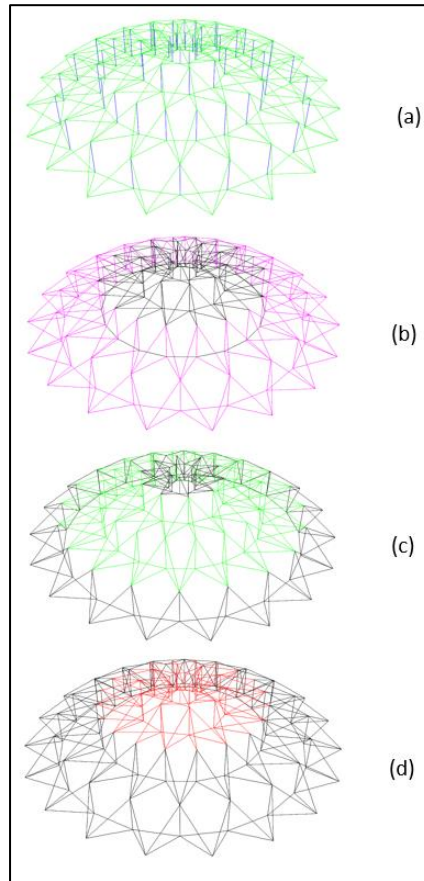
Secciones en las que se dividió la estructura para determinar el nivel de pretensado en los cables. (a) Estructura original, (b) Primera sub división que contempla nivel 1 y 2 de cables en color morado, (c) Segunda sub división que contempla niveles 2 y 3 de cables en color verde, (d) Tercera sub división que contempla niveles 3 y 4 de cables en color rojo.
